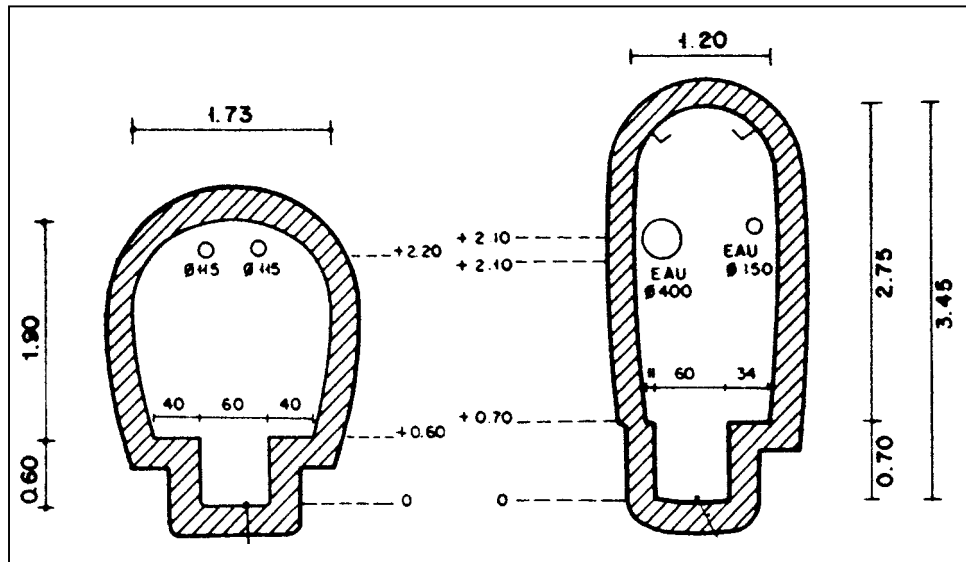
sections types des collecteurs St Gilles (à gauche) et Vieille du Temple (à droite)
